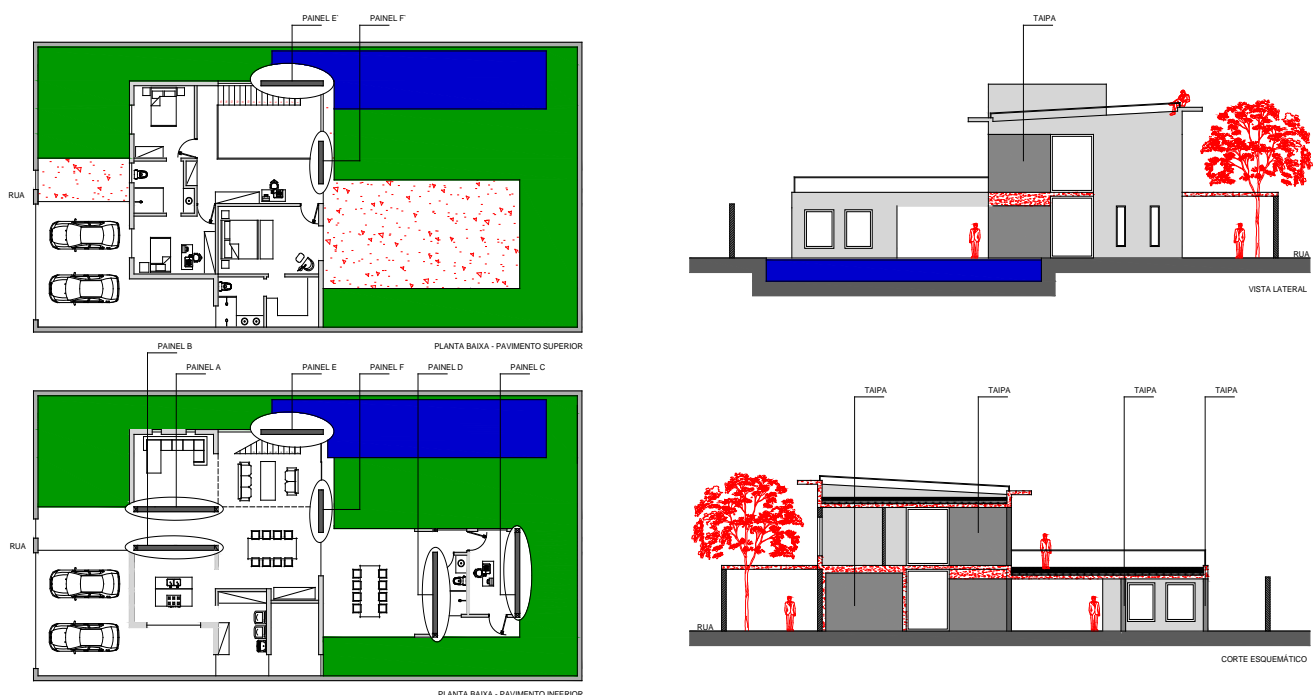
Desenhos de planta baixa, corte e vista do projeto arquitetônico
